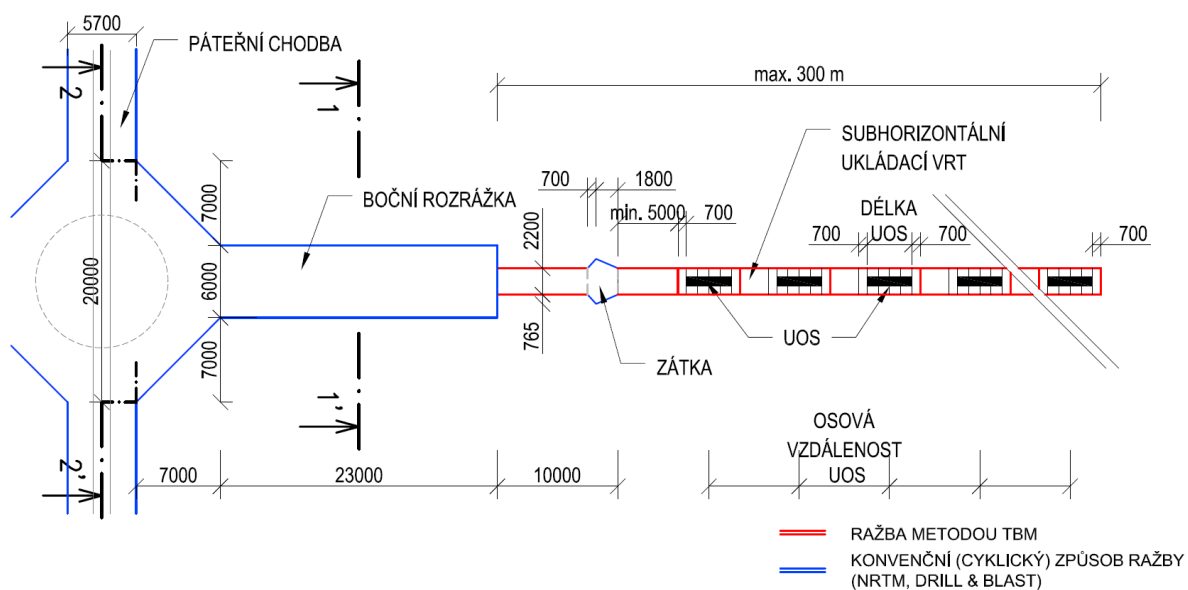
Půdorysné schéma ukládání – varianta D3
